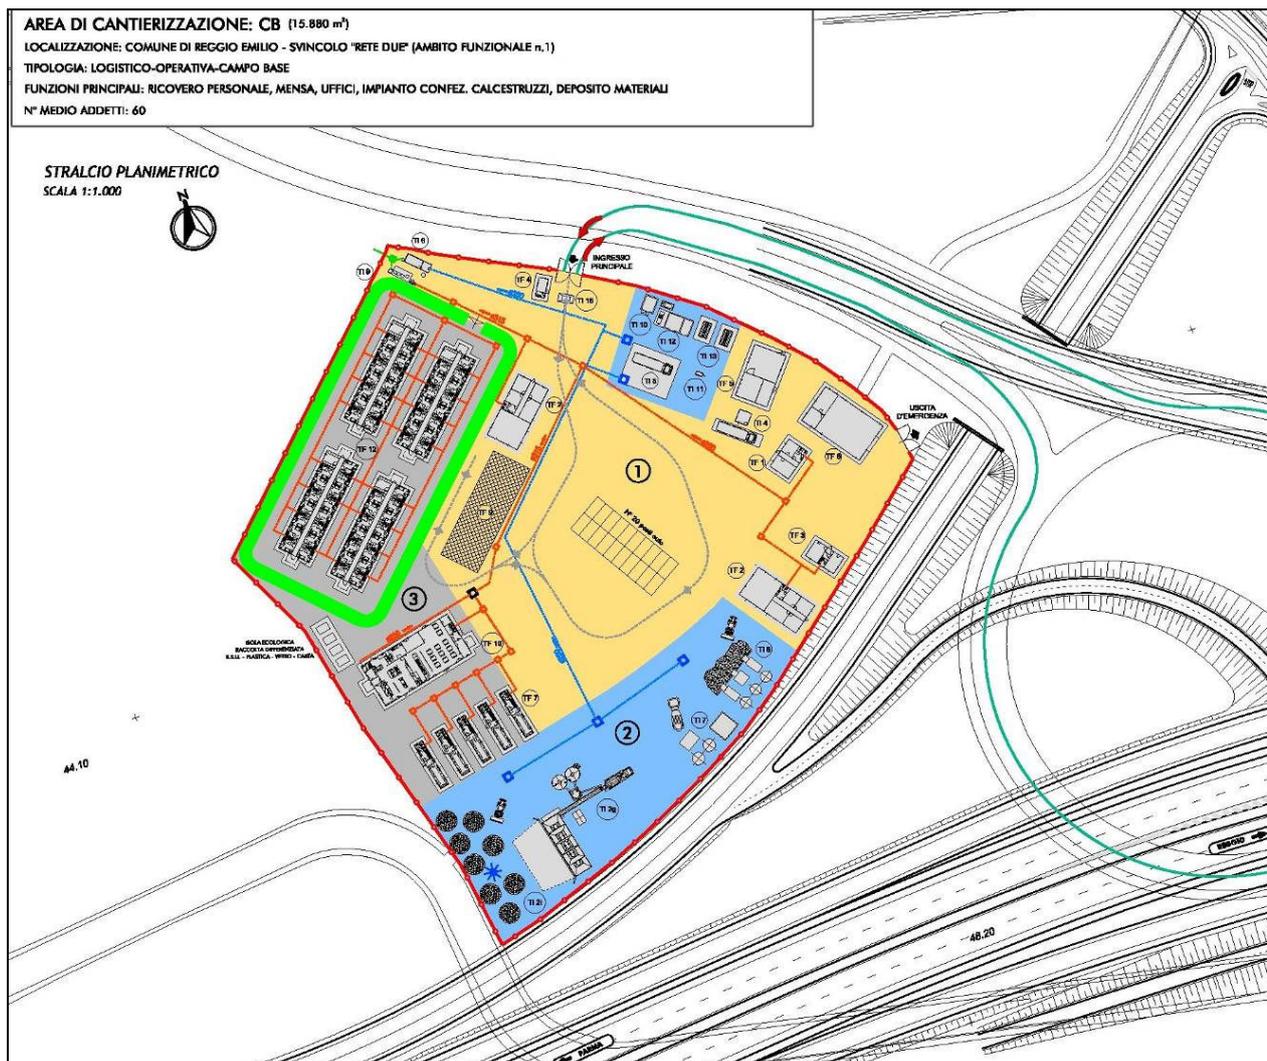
Layout aree di cantiere: campo base (stralcio planimetrico dell'elaborato T00IA24CANLF01A).
